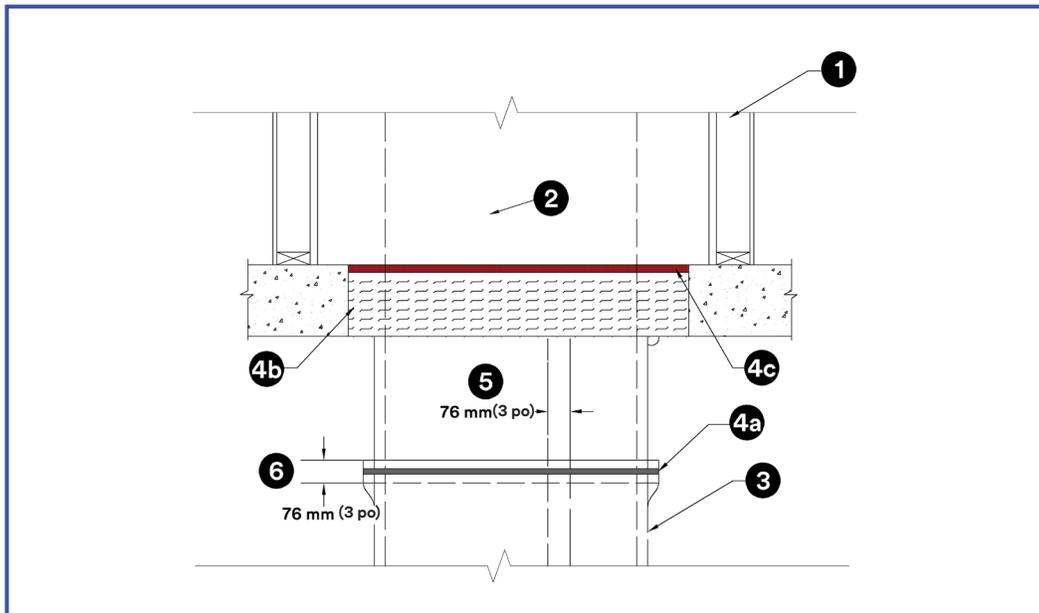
Transition suggérée entre l’enveloppe isolante d’un conduit de ventilation et la cheminée en gypse
